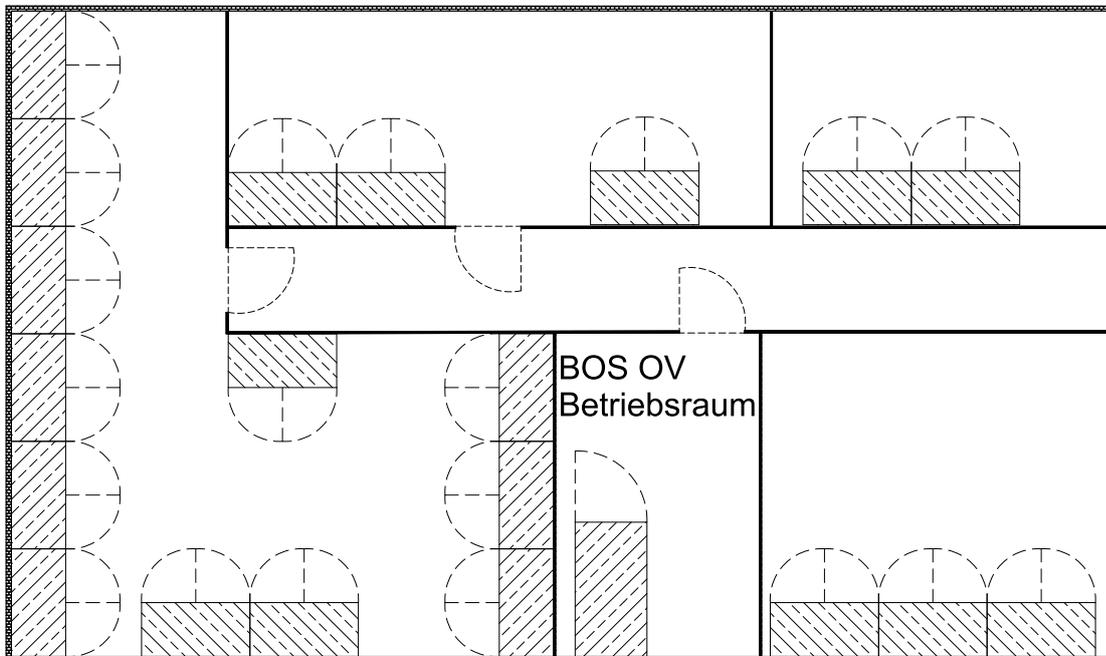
Plangrundriss mit eingezeichnetem BOS OV-Betriebsraum
